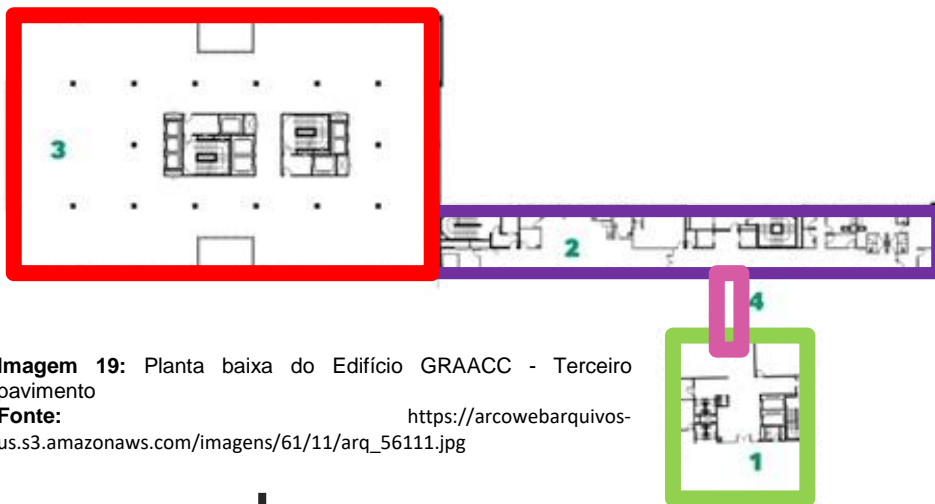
Planta baixa do Edifício GRAACC - Terceiro pavimento
